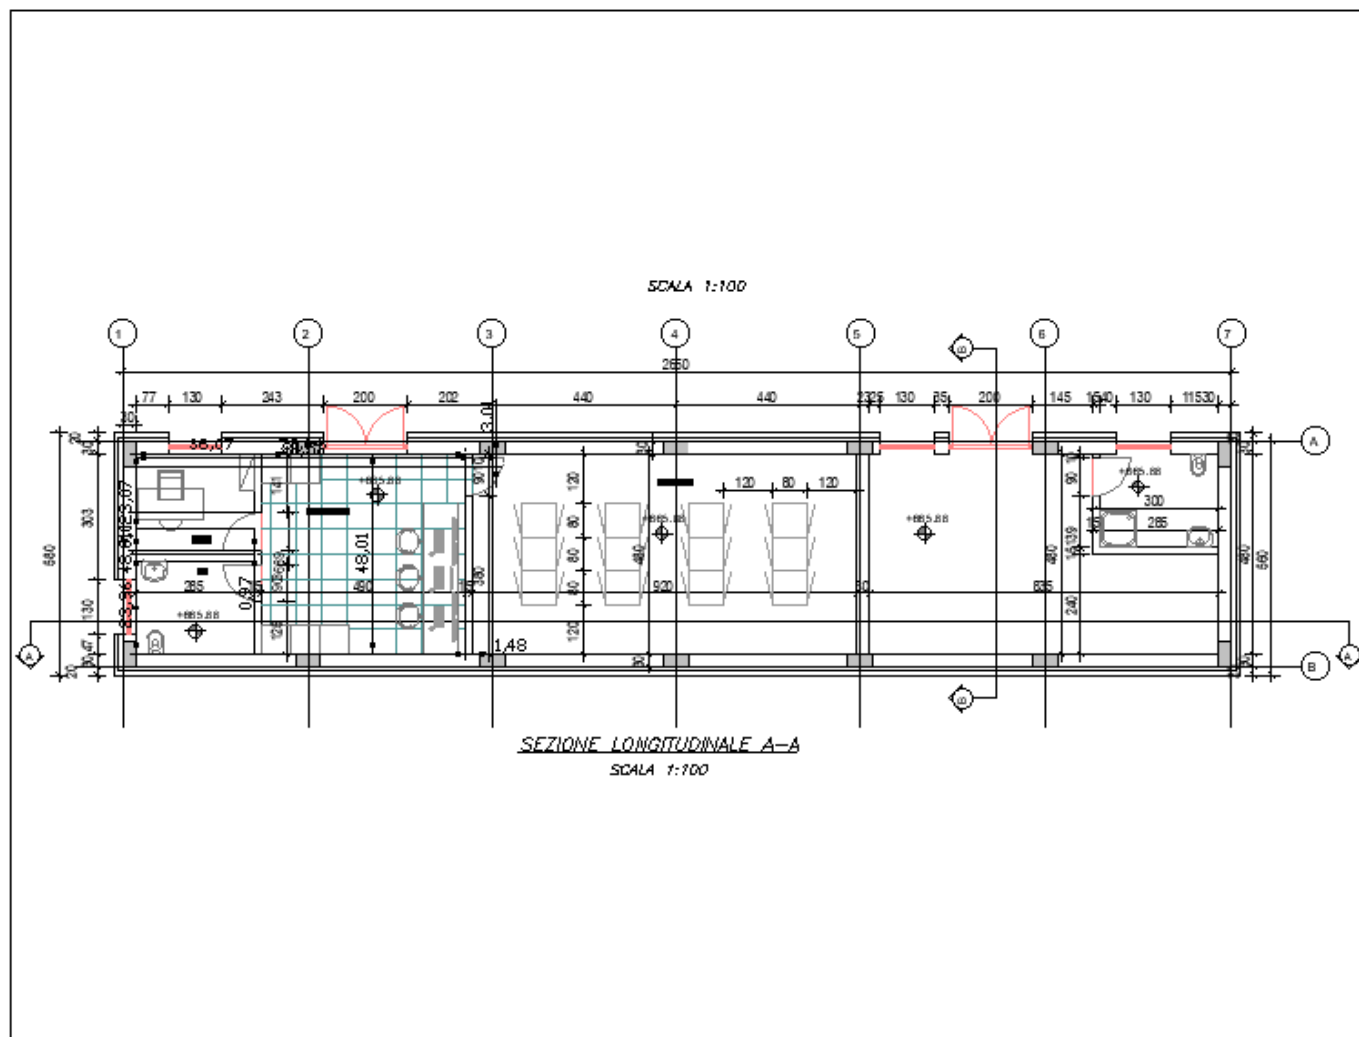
Planimetria uffici – sezione Longitudinale in scala 1:100
